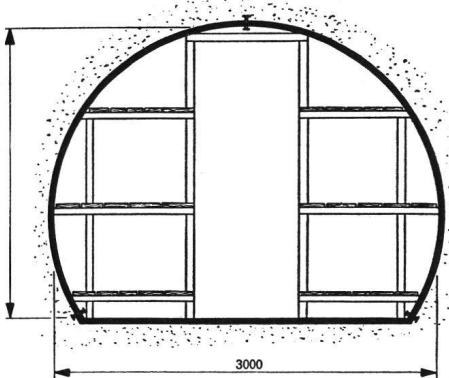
Tunnelunterstand mit Holzbau und Durchgang.
